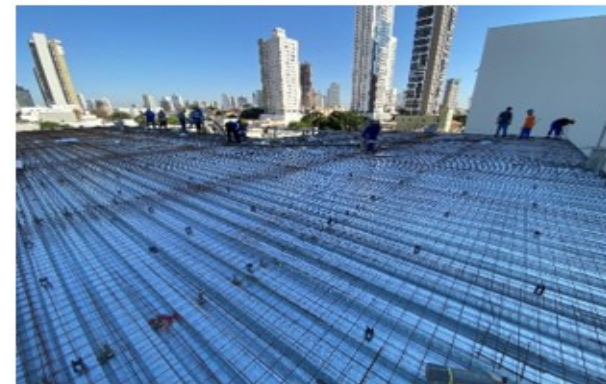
Laje Mista Steel Deck com Stud Bolts - Fonte: Autor
